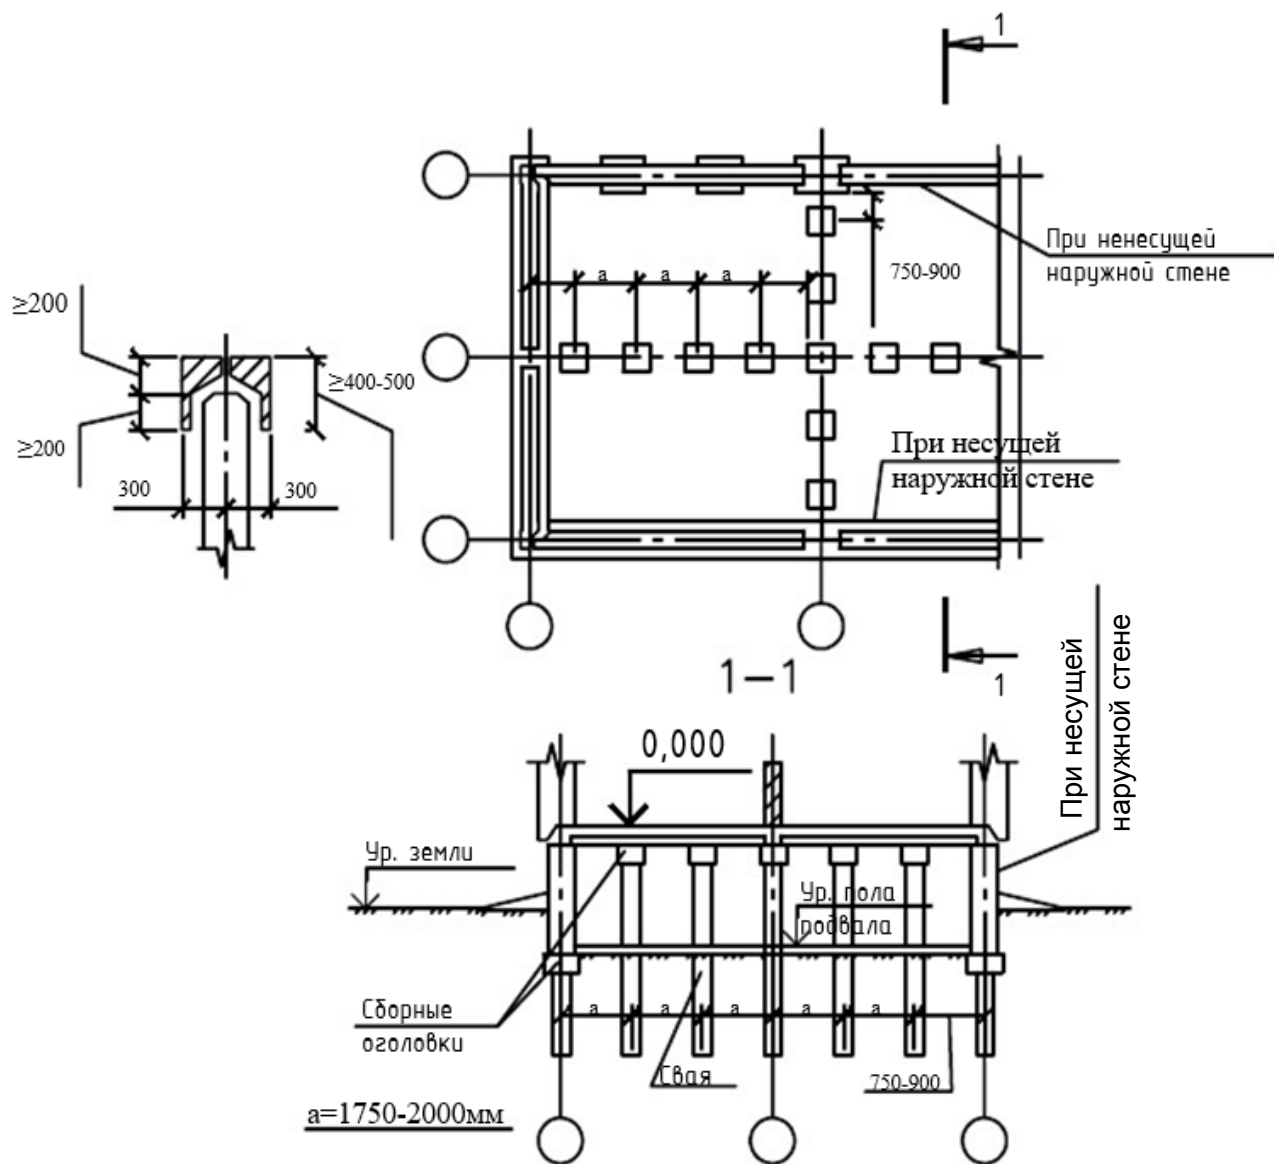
Схема безростверкового свайного фундамента со сборными оголовками
